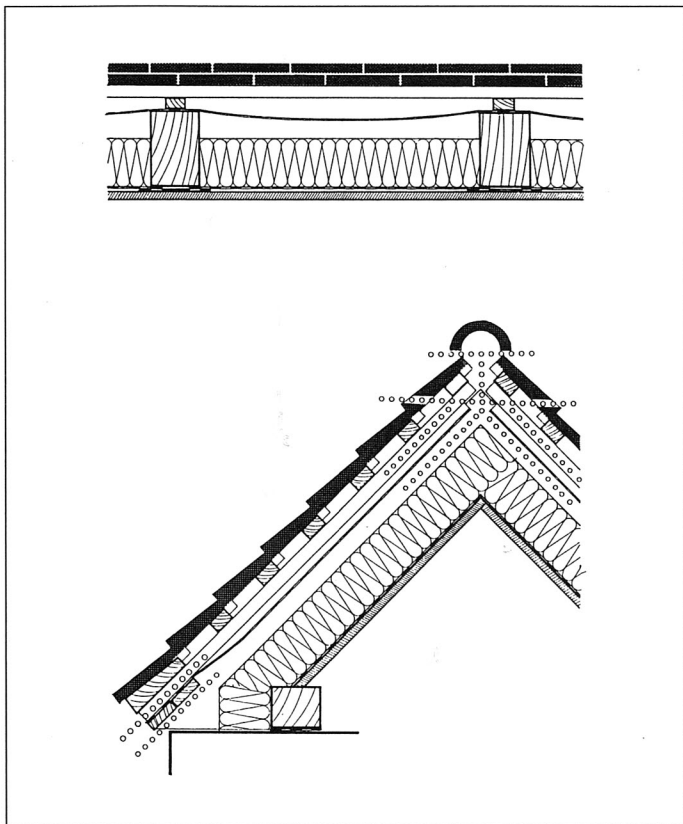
Konstruktionsschema für ein Steildach mit Wärmedämmung zwischen den Sparren nach den Dachdeckerrichtlinien [5].
